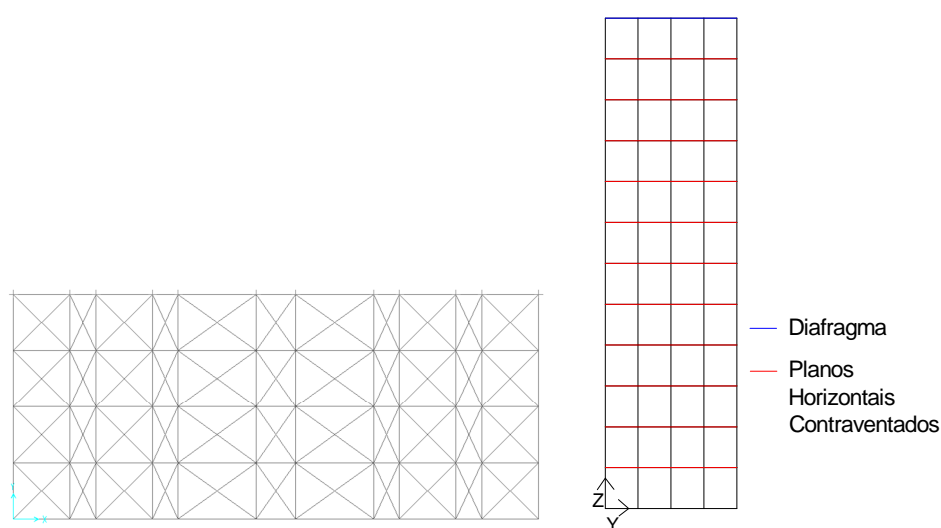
Configuração dos Planos de Contraventamento Horizontal Com Elementos de Contraventamento Pequenos
